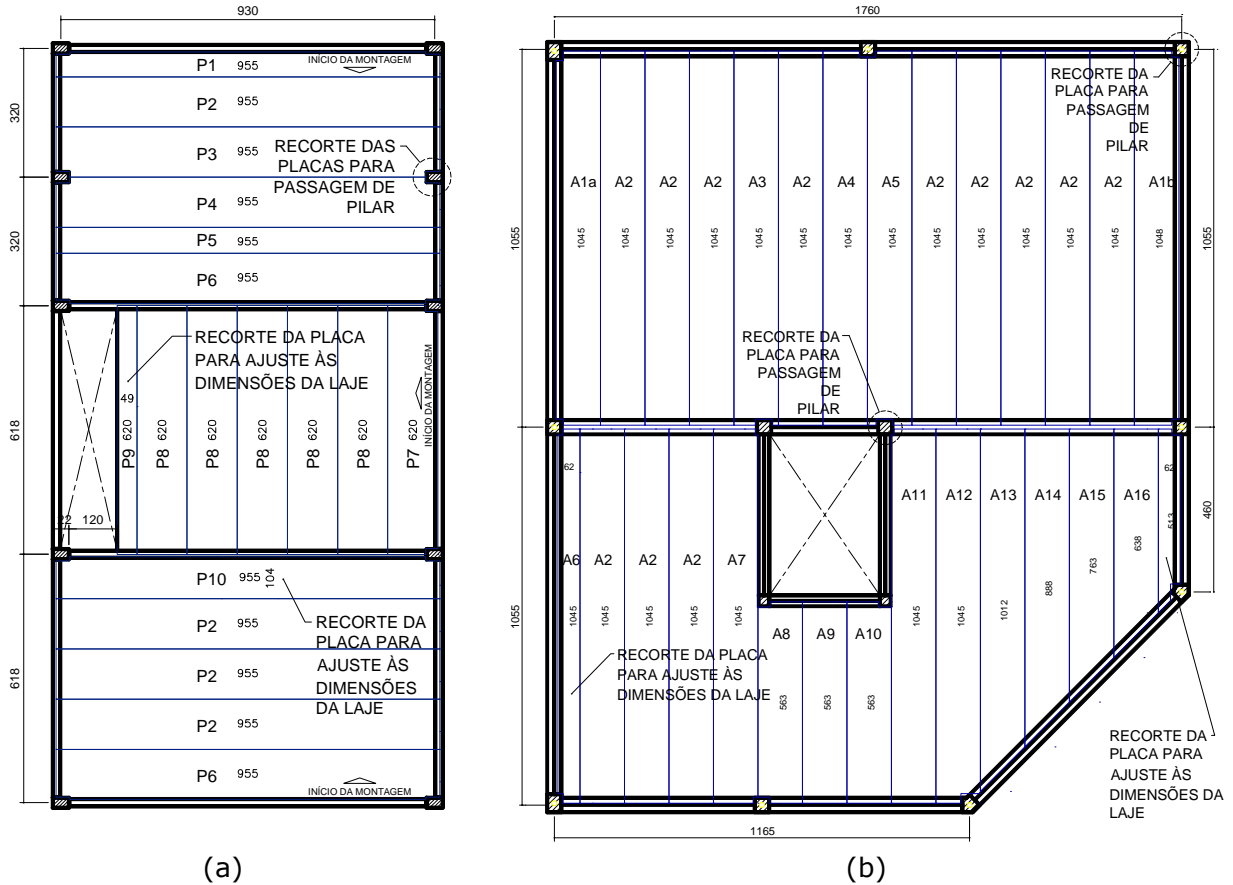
Ilustração do recorte das placas na posição de pilar que segue para o próximo pavimento
